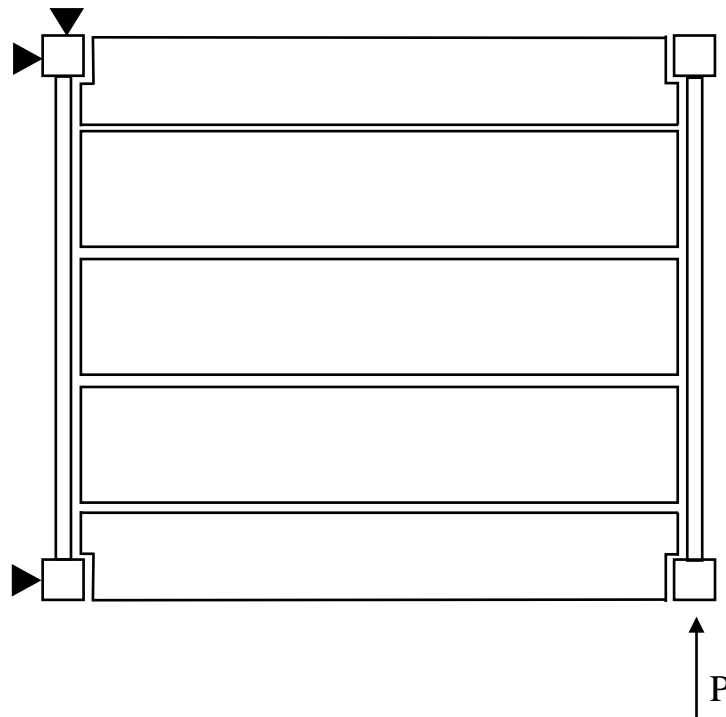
Схема приложения нагрузок при испытании фрагментов Ф-3, Ф-4 и Ф-5.
